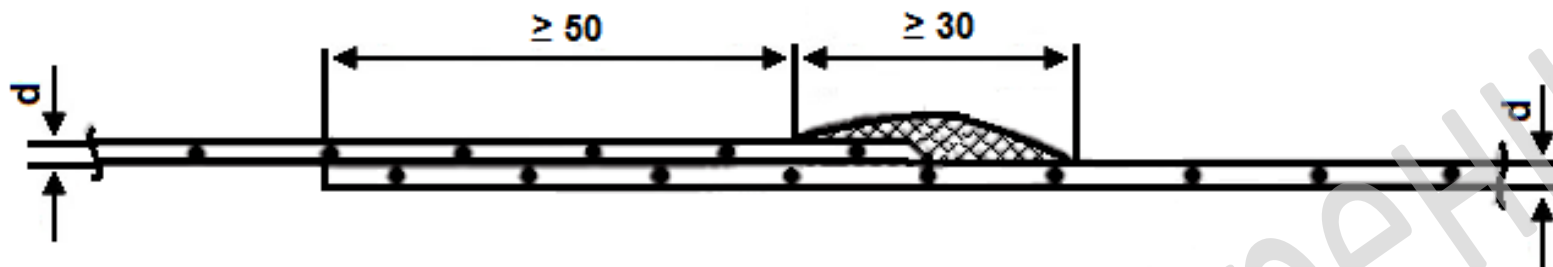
Сварное соединение полученное методом экструзионной сварки с предварительным нагревом соединяемых поверхностей (используется в основном для целей ремонта, усилений и там, где невозможно получить соединений с проверочным каналом).
